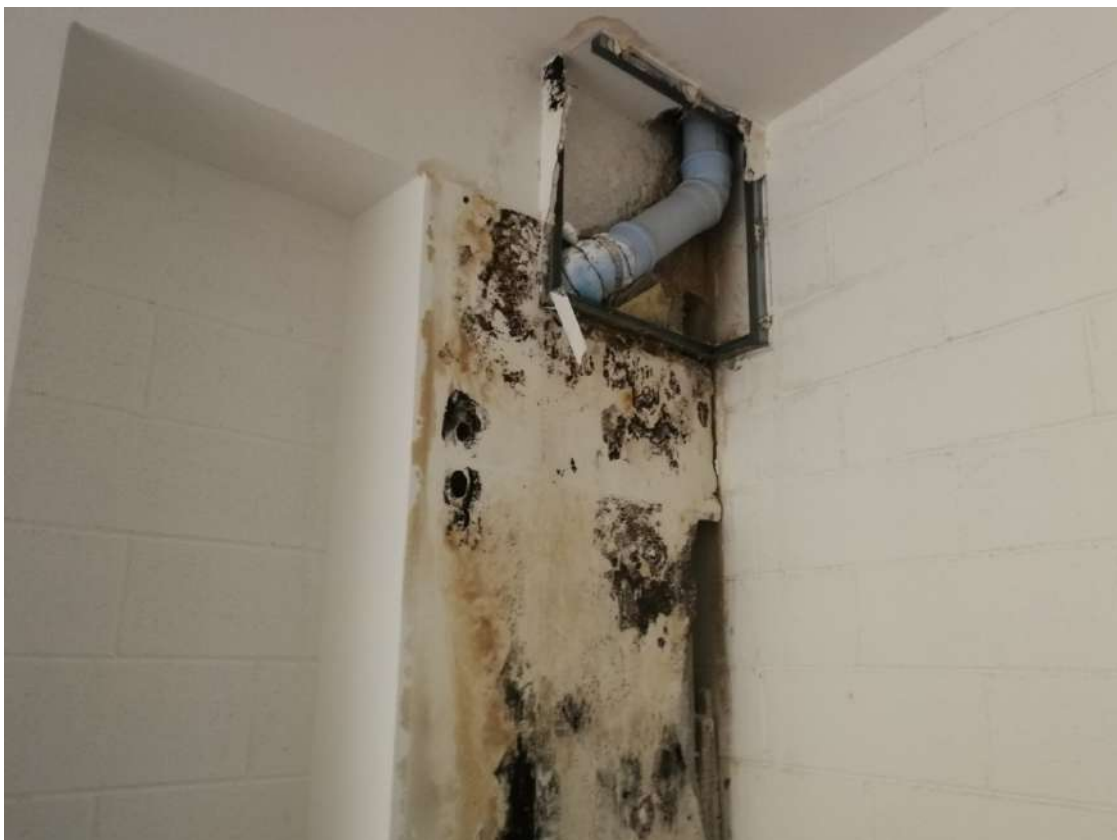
Lotto n° 2 – Danneggiamento dell'impianto elettrico
